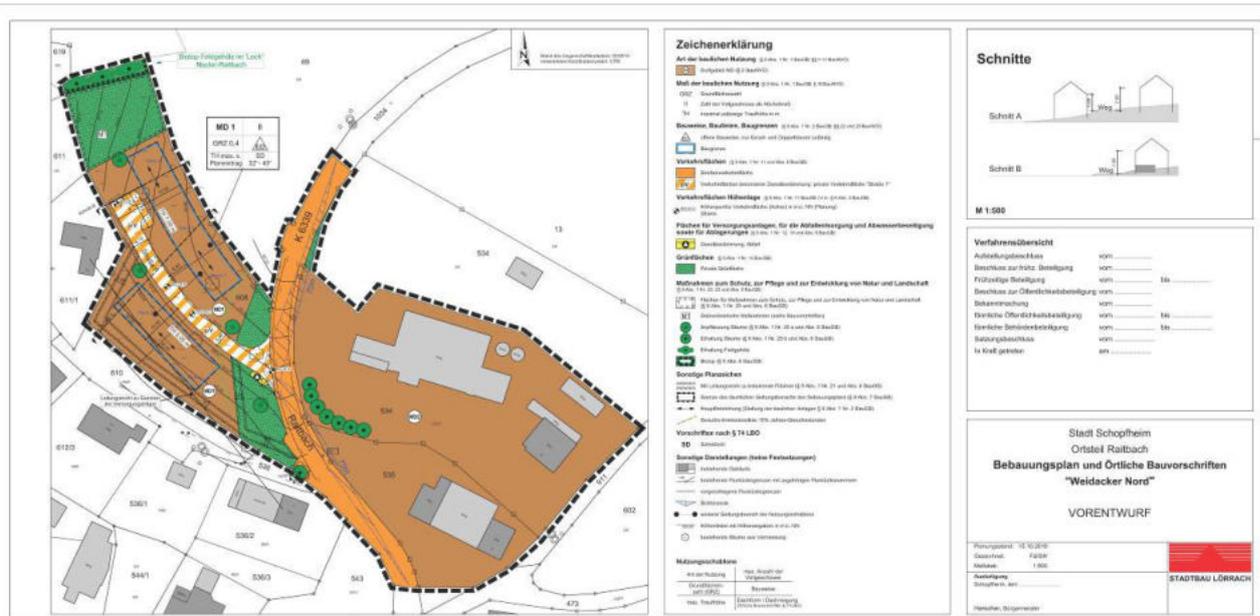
Bebauungsplan Weidacker Nord (Quelle: Stadtbau Lörrach)
